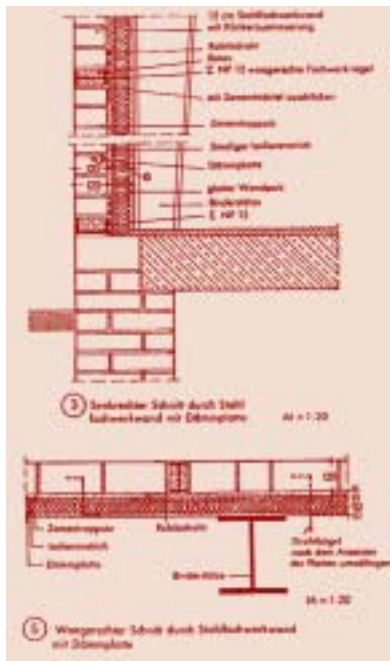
Vertikal- und Horizontalschnitt durch Stahlfachwerkwand mit Dämmplatte, Schupp [Quelle: Henn, Walter, Bauten der Industrie, Bd. 2, München 1955]
